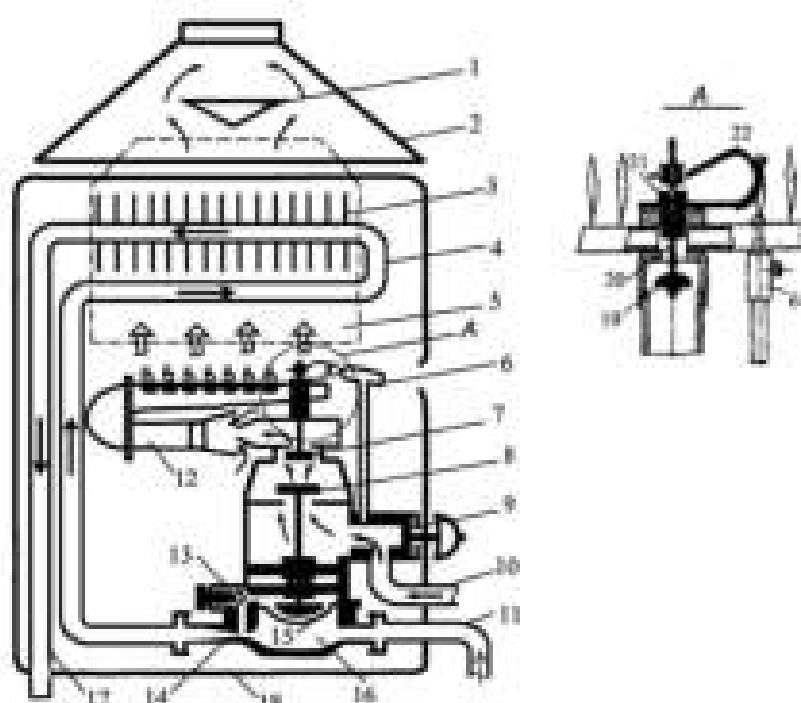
Принципиальная схема водонагревателя ВПГ: 1- предохранитель от обратной тяги; 2- газоотводящее устройство; 3- калорифер; 4- змеевик; 5- огневая камера; 6- запальник; 7- клапан безопасности; 8- клапан блокировки газа; 9 - блок-кран; 10 - вход газа, 11 - вход воды; 12 - горелка; 13 - шариковый замедлитель зажигания; 14 - трубка Вентури; 15 - мембрана; 16 - мембранный камера; 17 - выход воды; 18 - кожух; 19 - клапан; 20 - шток; 21 - уплотнение; 22 - биметаллическая пластина
